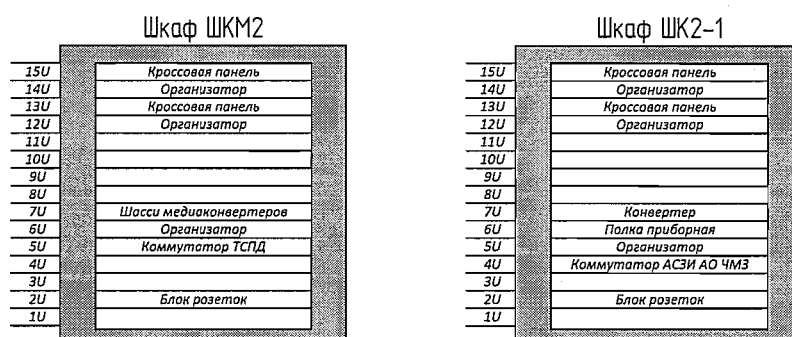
Корпус 450. Шкафы ШКМ2 (существующий) и ШК2-1(вновь установленный). Расположение оборудования.
